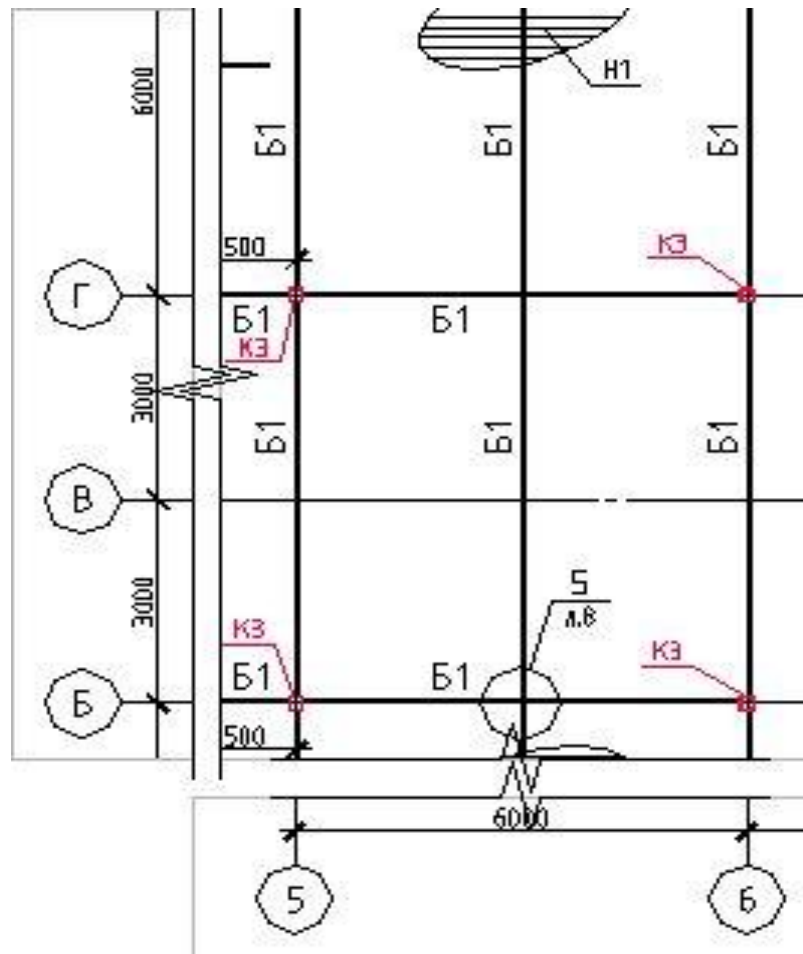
Схема балок перекрытия и покрытия.
